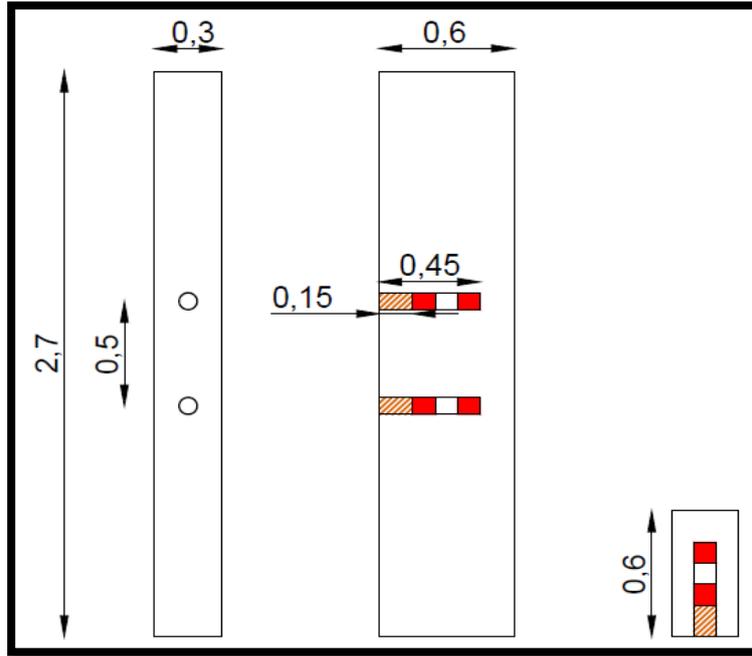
Alzado, perfil y planta del pilar "Básico 1".
